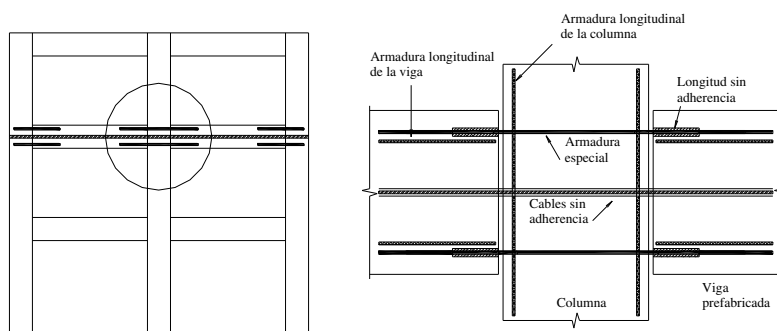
Vista en elevación de un pórtico conformado por elementos postesados. Disposición de los dos tipos de armaduras en el nudo híbrido.
